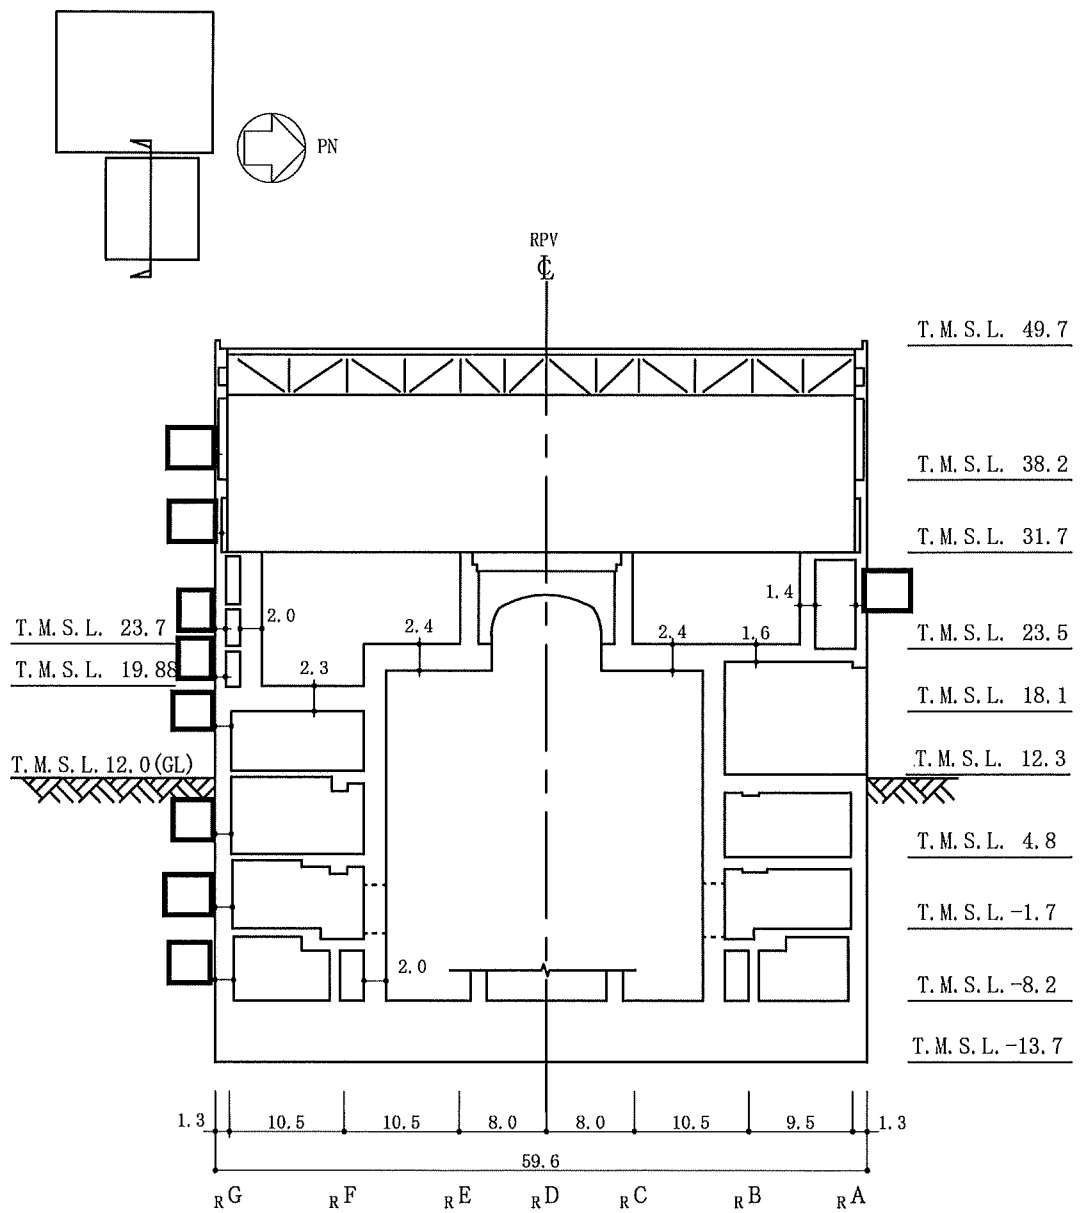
原子炉建屋の概略断面図 (EW方向) (2/2) (単位 : m)
